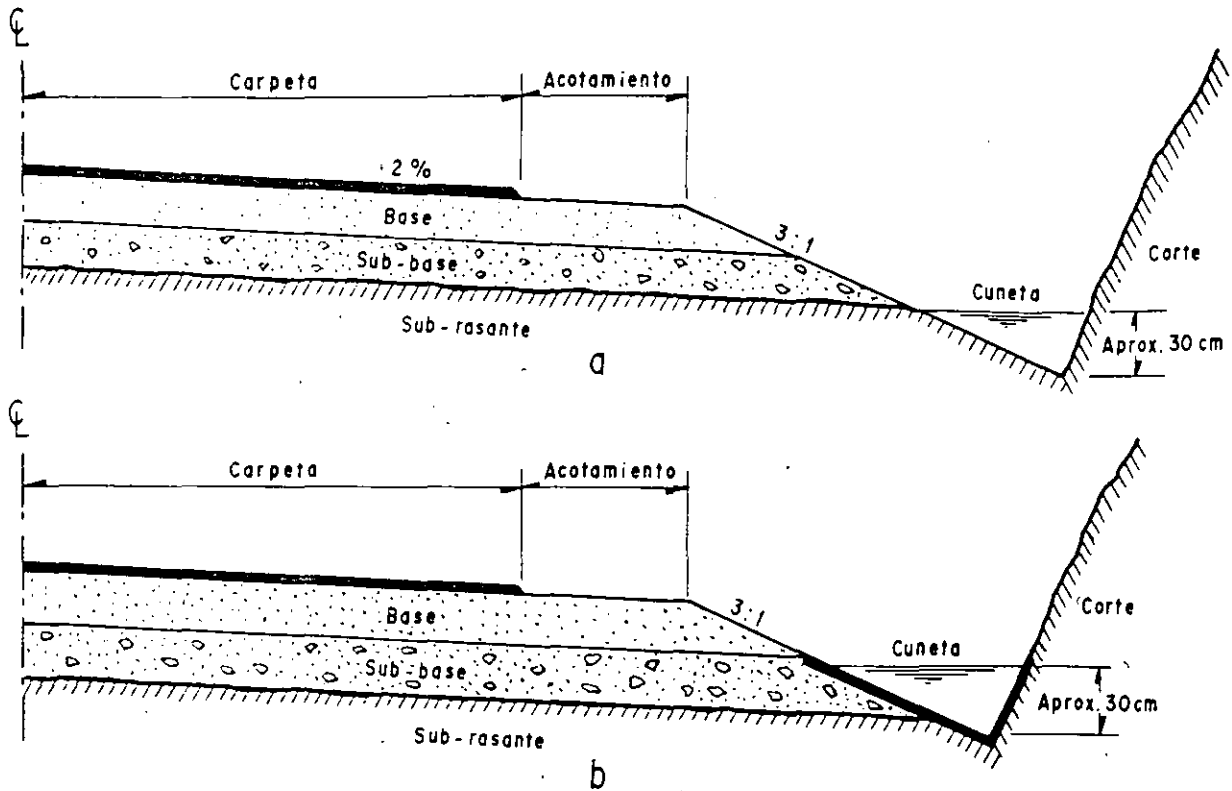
Disposición más conveniente de la cuneta, respecto al pavimento. Sección en corte, sin subdrenaje.
